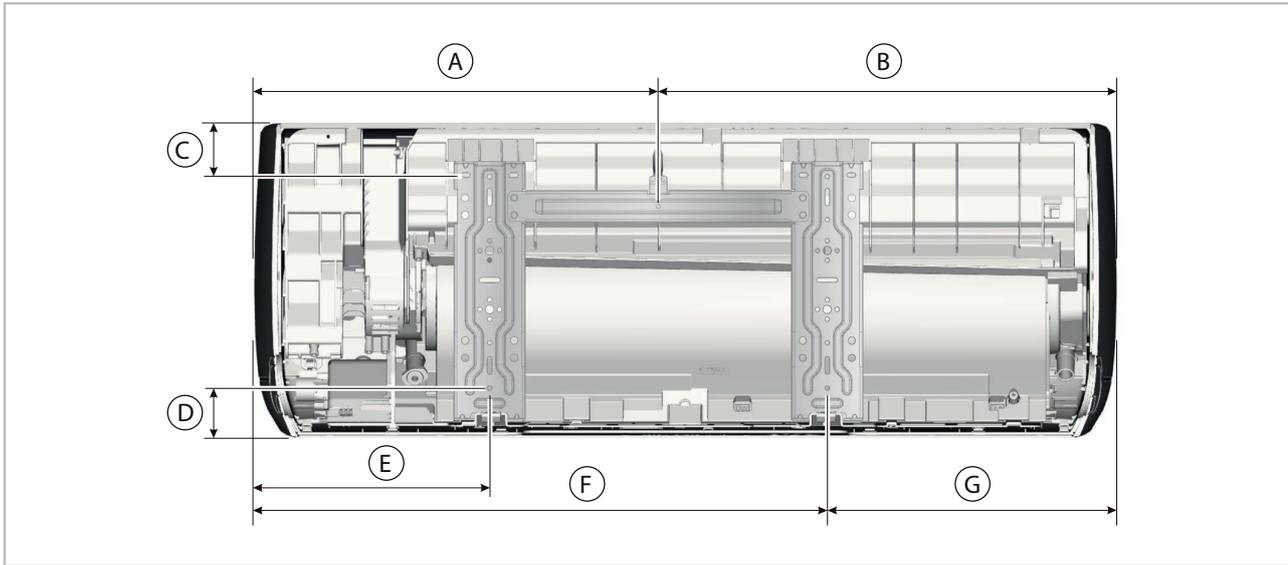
Montagepunkte der Wandhalterung BL 264-354 DC IT (Rückansicht, alle Maße in mm)
